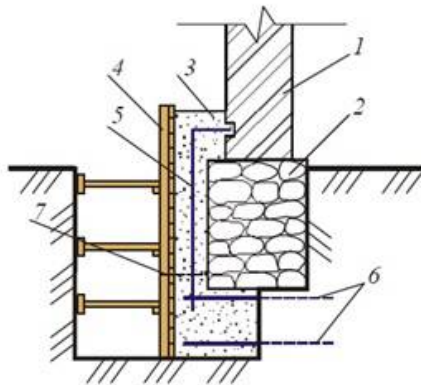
Схема увеличения глубины заложения фундаментов из бутовой кладки: 1 – стена; 2- фундамент; 3 – монолитный бетон; 4 – опалубка; 5 – арматурная сетка; 6 – горизонтальные арматурные стержни; 7 – уровень первого яруса бетонирования
